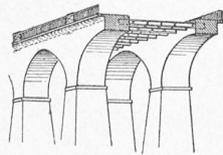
Type de pont mixte à arcs en maçonnerie et plancher métallique.
